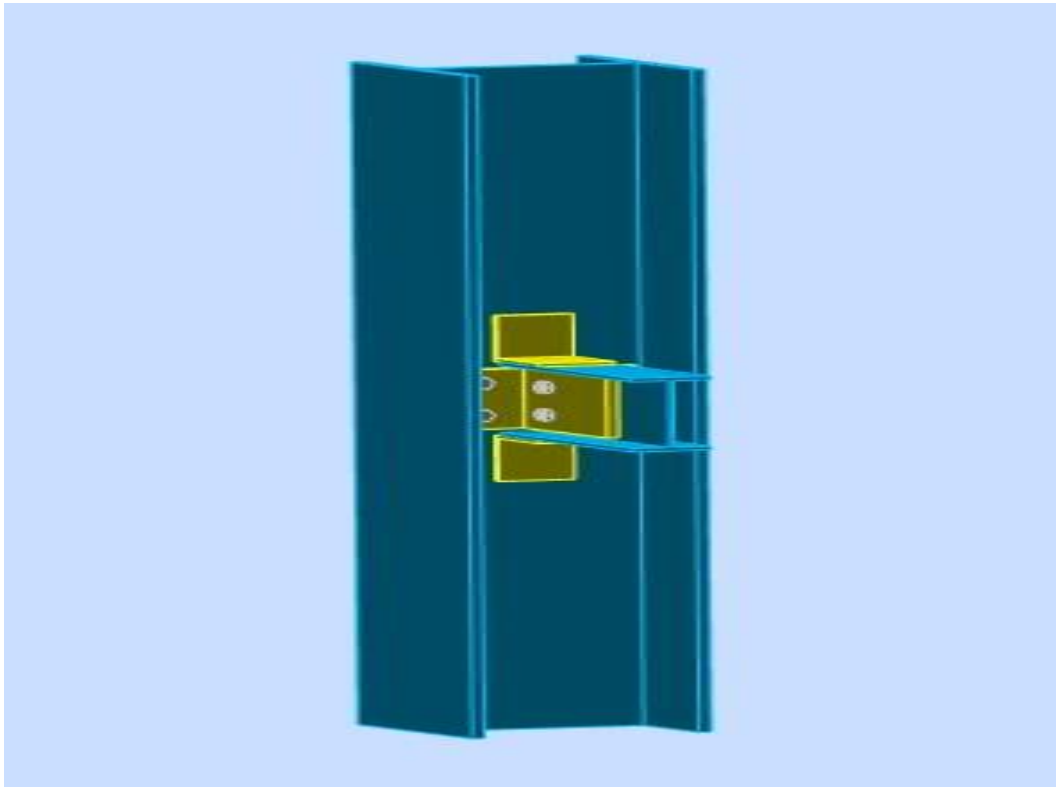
Schéma d'assemblage Poteau-poutre secondaire
